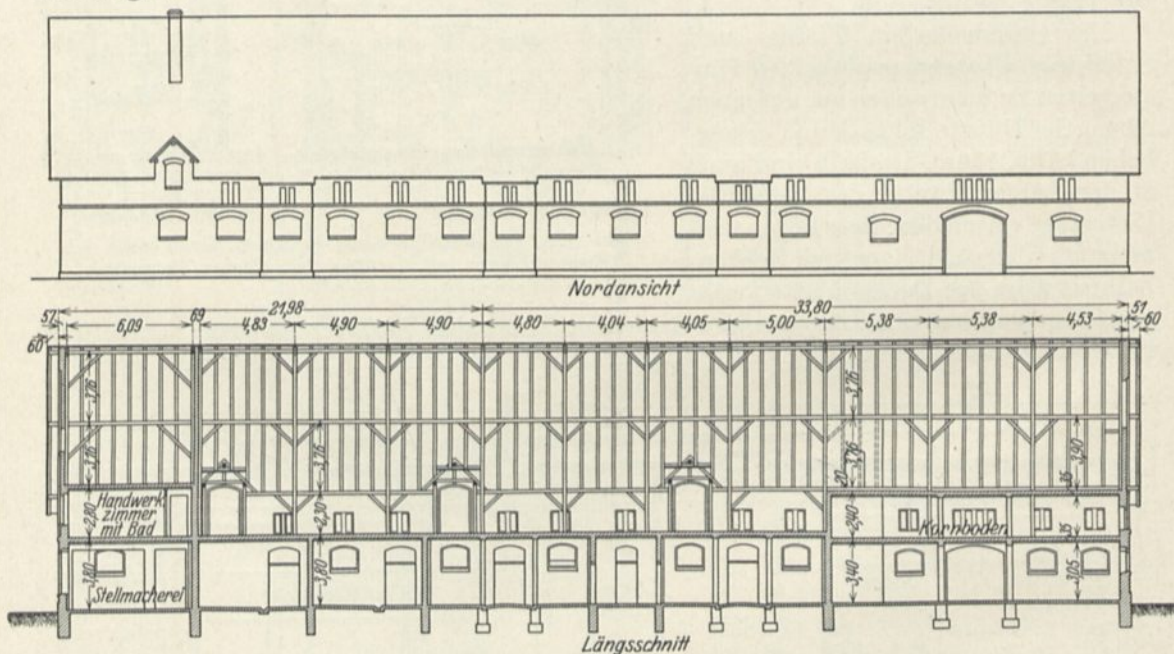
Pferdestallgebäude Baudach. Längsschnitt und Ansicht.
